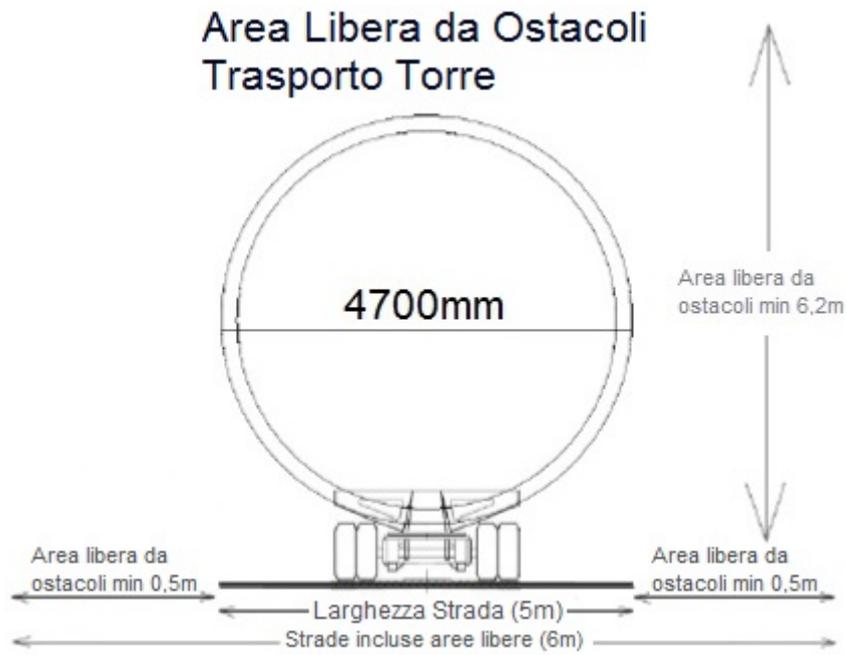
Trasporto eccezionale sezione 1 torre aerogeneratore in progetto
